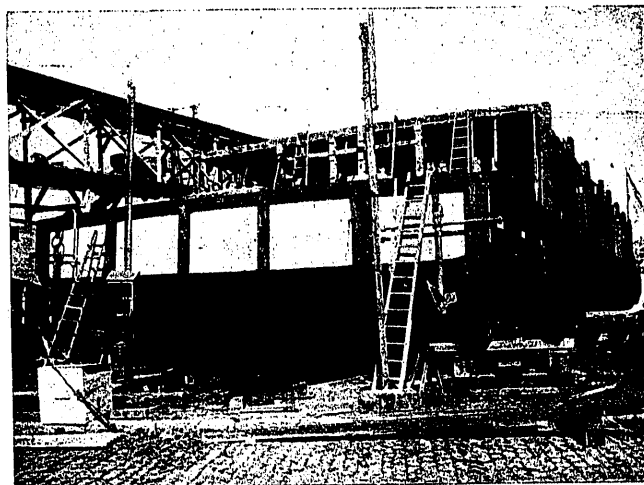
Embarcadero flotante dispuesto para el lanzamiento.
